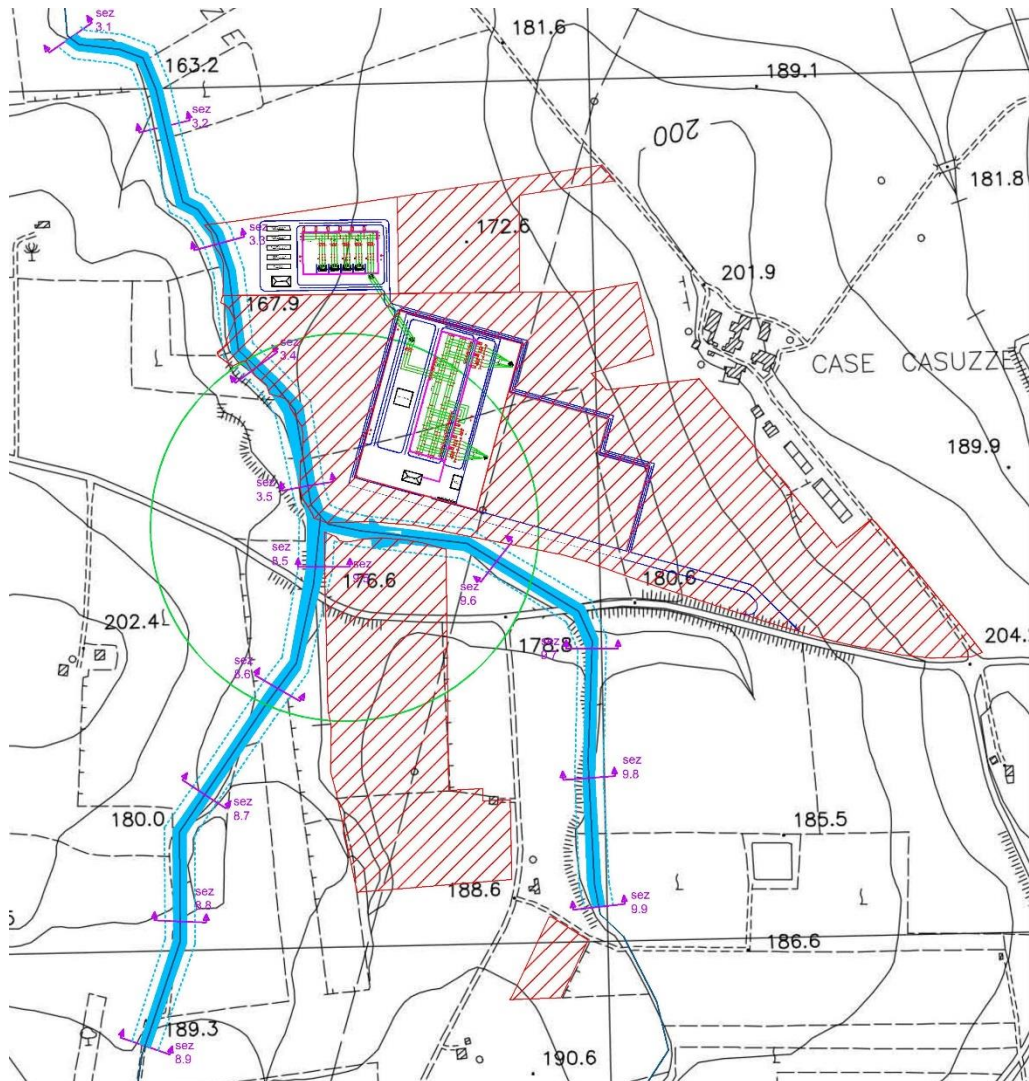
a - Individuazione e dettaglio di inondazione con sovrapposizione dell'area di interesse - Stazione Rete - Utente
